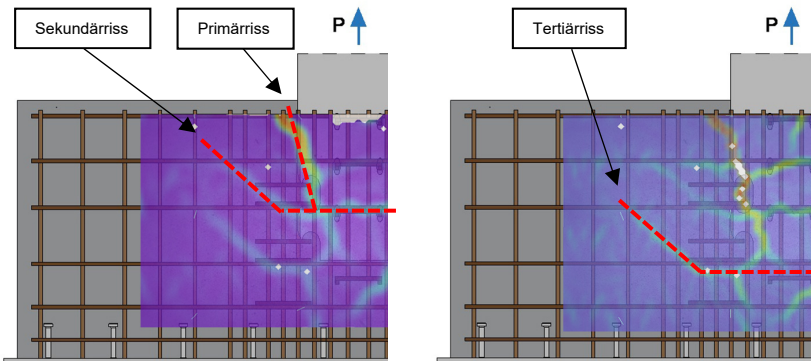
Darstellung der Betonausbruchkegel im Experiment VR5-ZV-3 (links: Betonausbruch II bei 365 kN; rechts: Betonausbruch III bei 394 kN)
